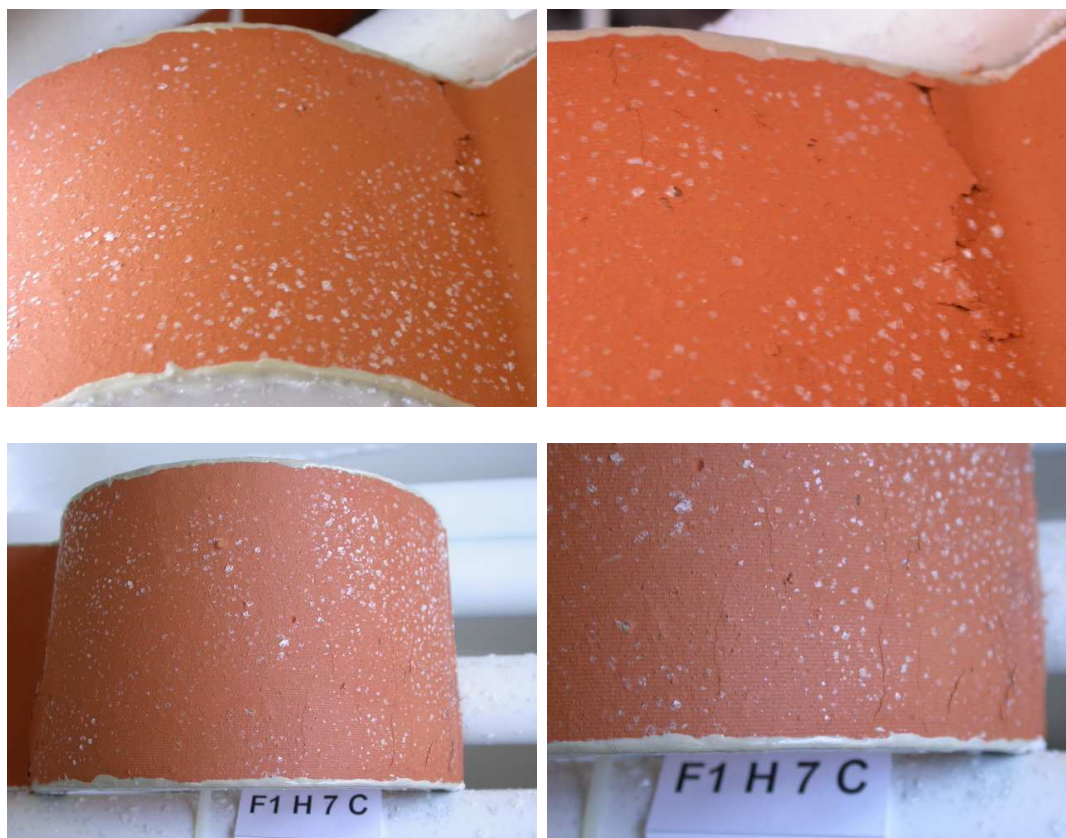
Pormenores da degradação do provete F1 H 7 C após ensaio
